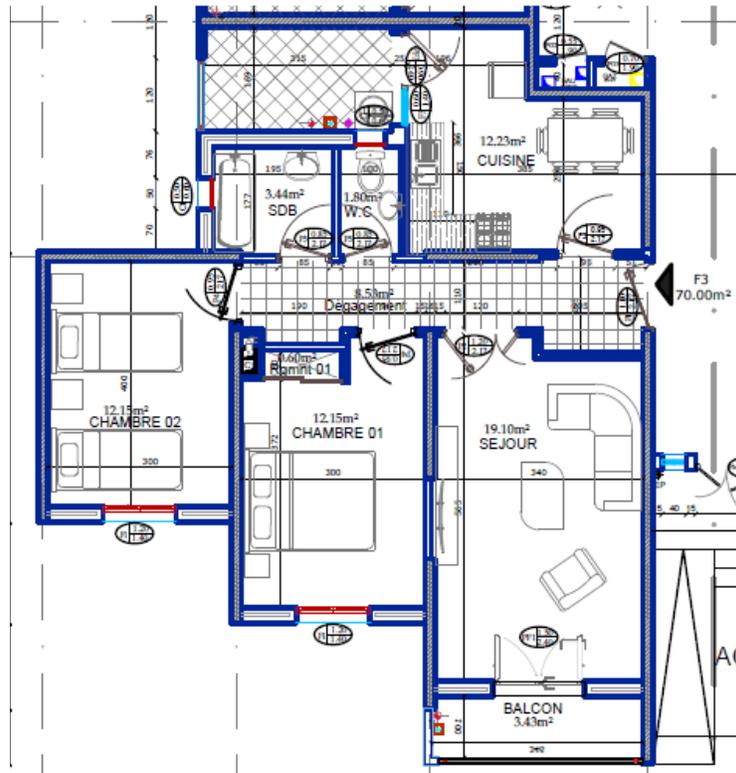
Plan d'un appartement F3 l'AADL de Sidi Abdallah
